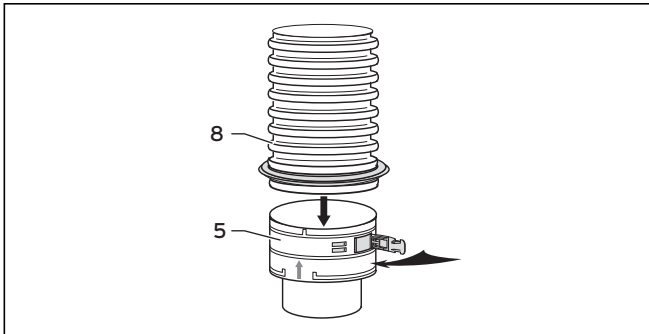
Einsteckelement mit flexibler Abgasleitung
